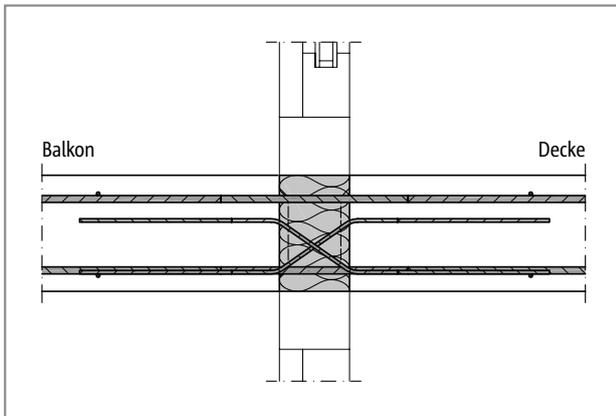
Schöck Isokorb® Typ DXT: Einbauschnitt; einachsrig gespannte Decke
